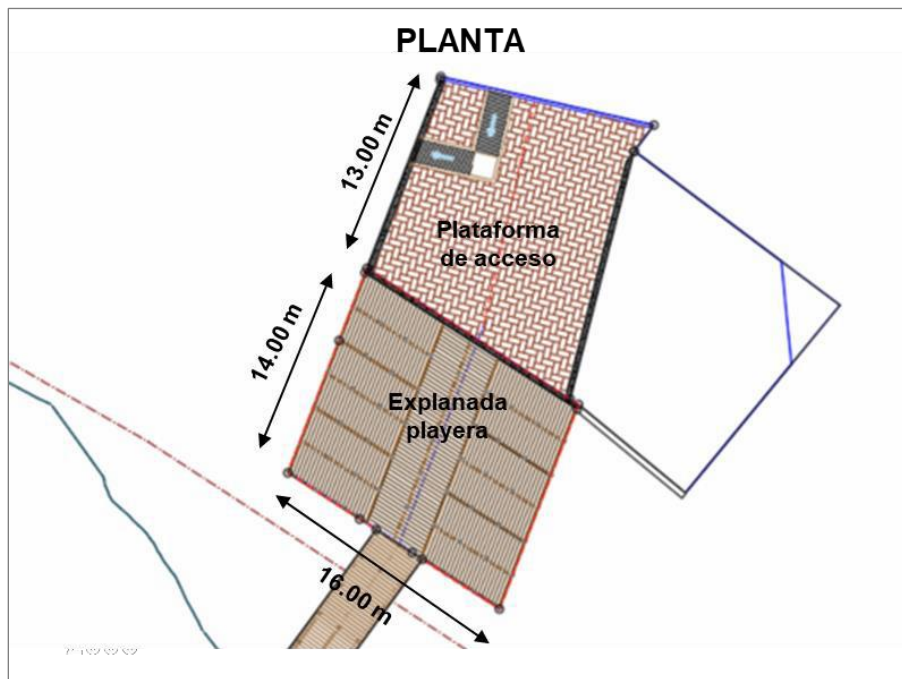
Plano en planta de la configuración de la explanada playera y la plataforma de acceso (Capitanía Local de Puerto) en el área del muelle turístico de Bahía de Kino, Sonora.
